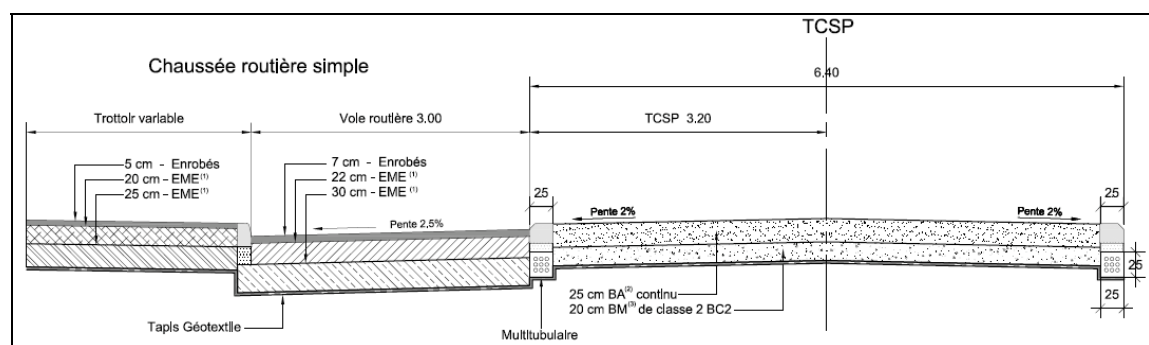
Coupe type de la structure de chaussée d'ÉVÉOLE de Douai
